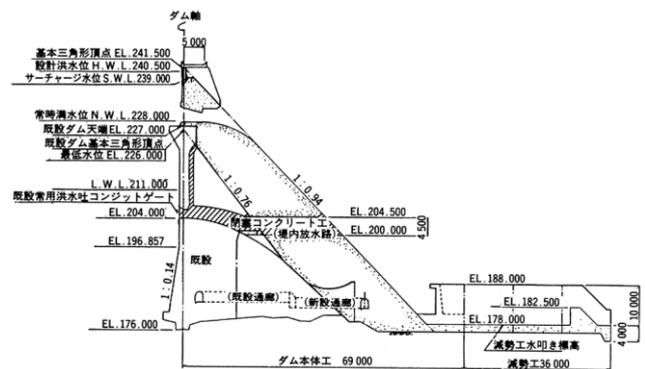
萱瀬ダムの嵩上げ後の標準断面図¹⁾
